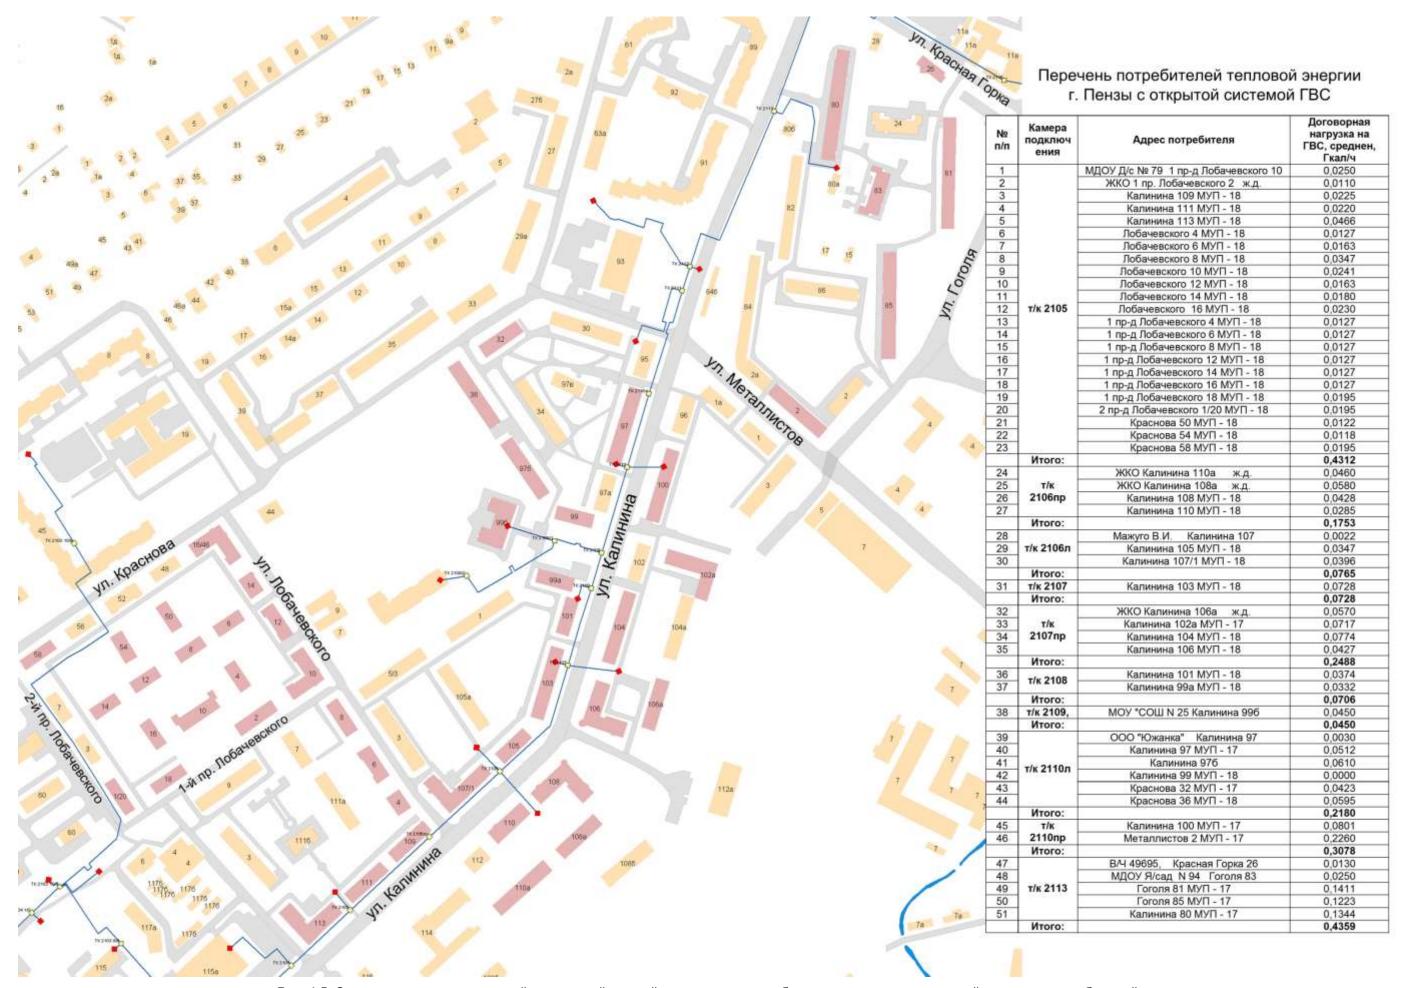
Схема расположения зданий с открытой схемой горячего водоснабжения с указанием тепловой нагрузки потребителей
